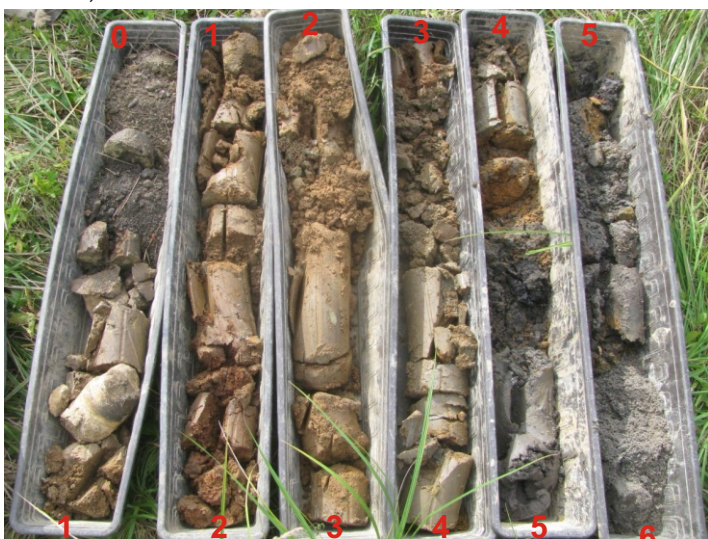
vyvrtané jádro vrtu J1 v metráži 0 - 6 m
